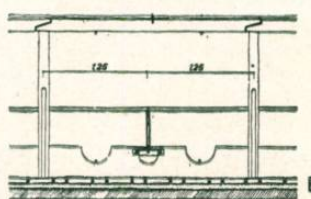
Detaliu de iesle prefabricată din beton armat
